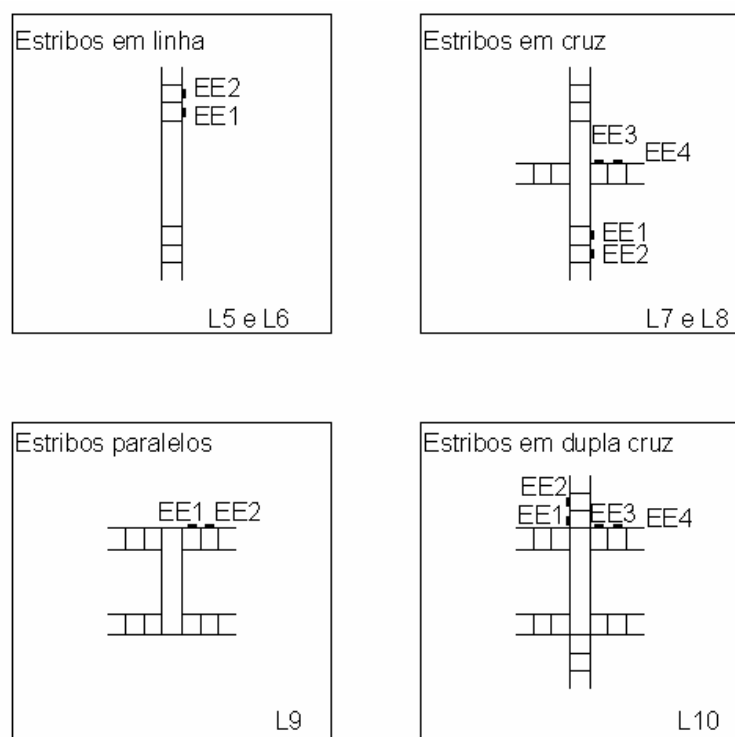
Posição dos estribos na armadura de cisalhamento
